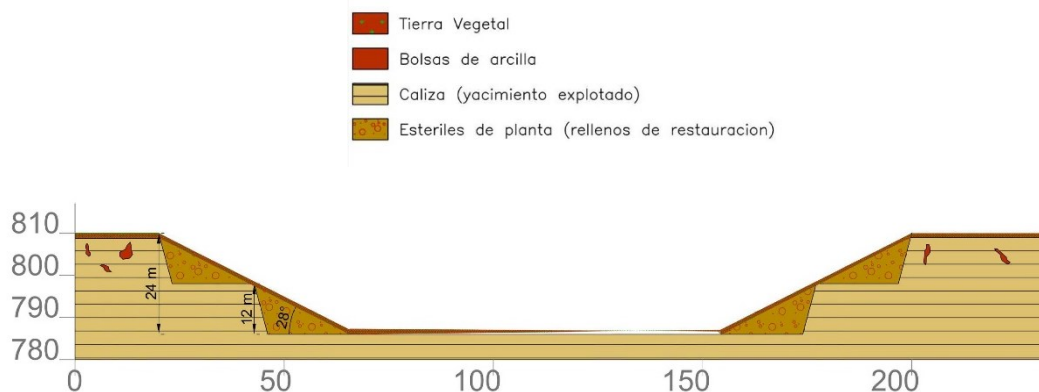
Perfil tipo de taludes y plaza de cantera. Elaborado a partir del Plan de Restauración.
